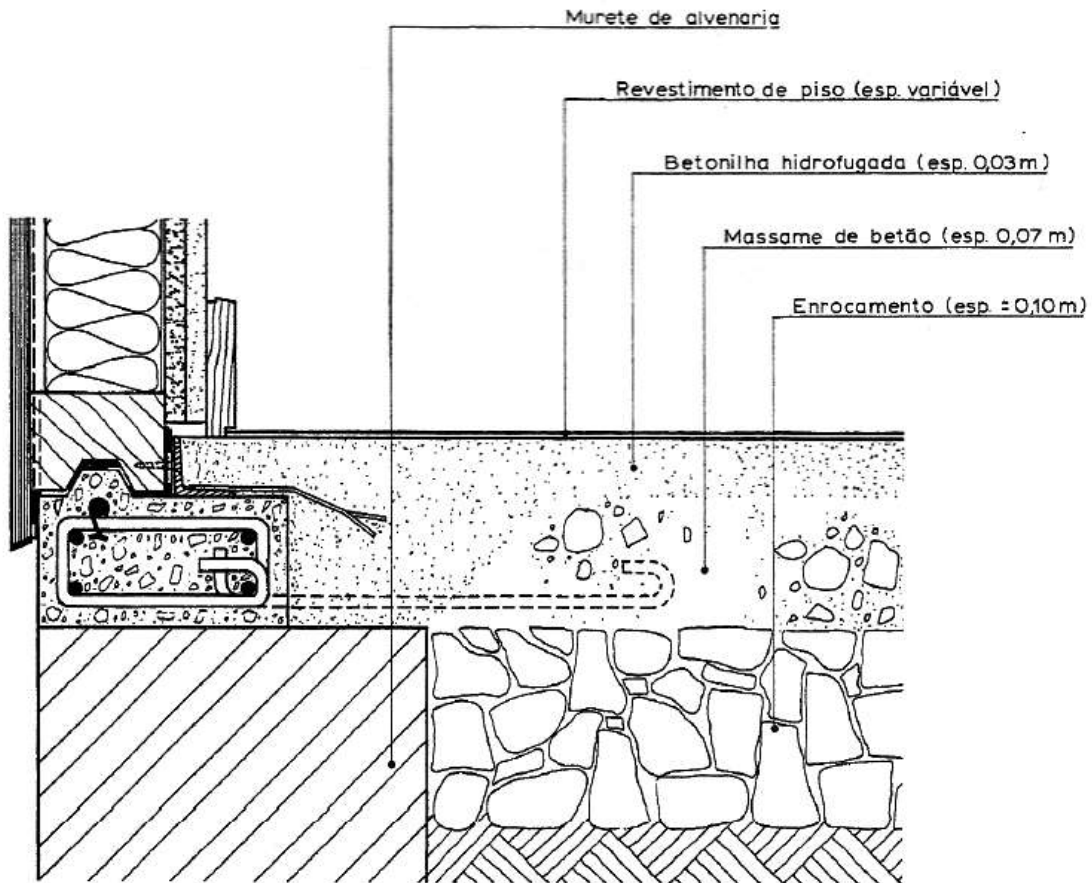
Execução do pavimento (Mesquita Madeiras, 2004)
